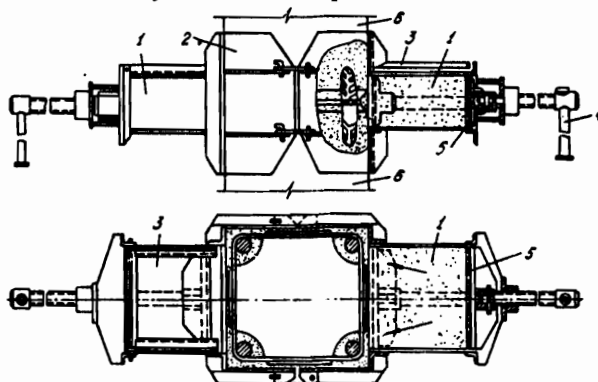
Пресс-опалубка для замоноличивания стыков колонн бетонной смесью; 1 – камеры нагнетания; 2 – опалубка; 3 – крышки; 4 – рукоятка; 5 – пуансон; 6 – колонны
